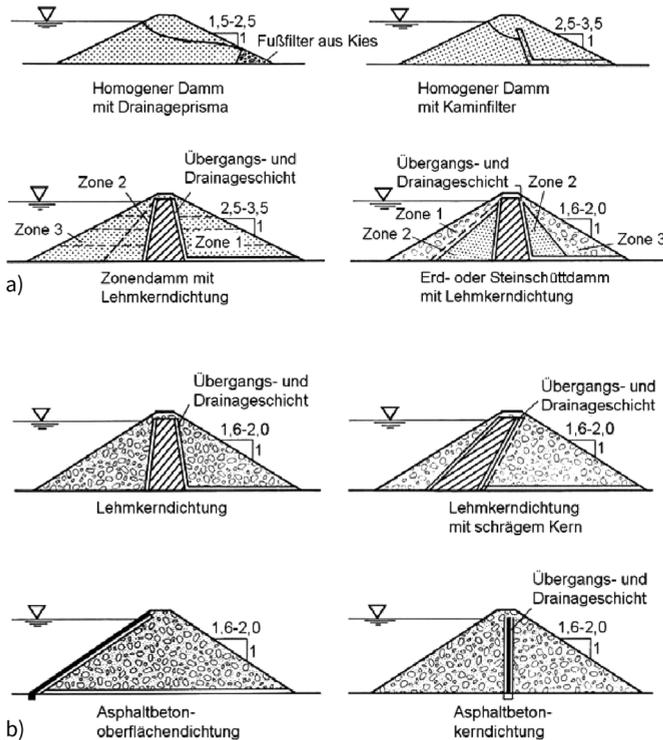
Prinzipskizzen verschiedener Dammtypen von Erd- und Steinschüttdämmen (nach [51]);
